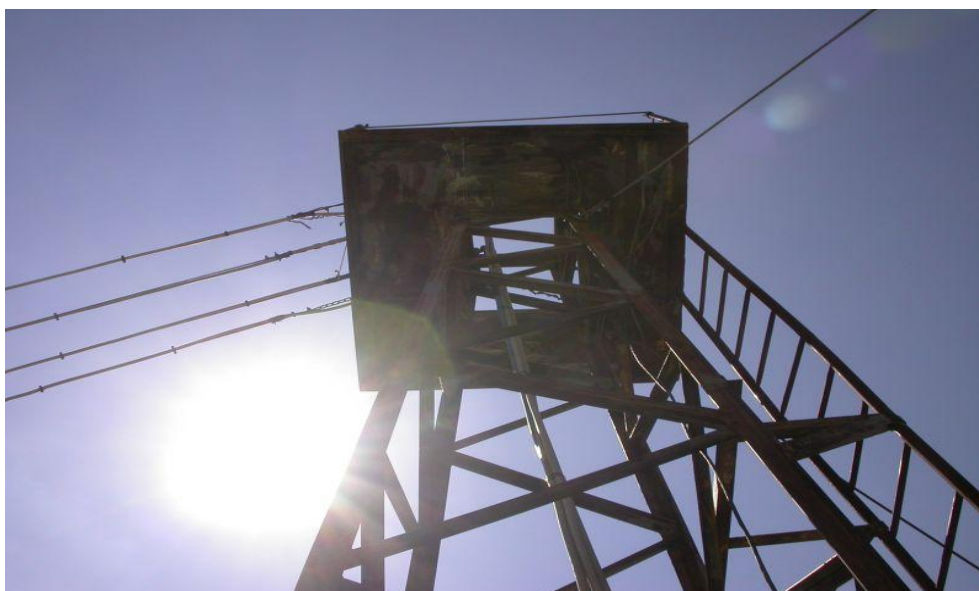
Linee aeree in cavo attestate su un traliccio
